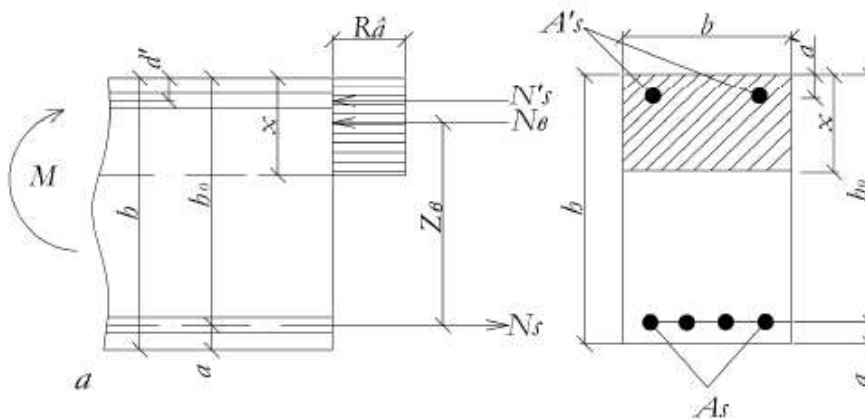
Для розрахунку перерізу згинального елемента прямокутного форми з подвійною арматурою
